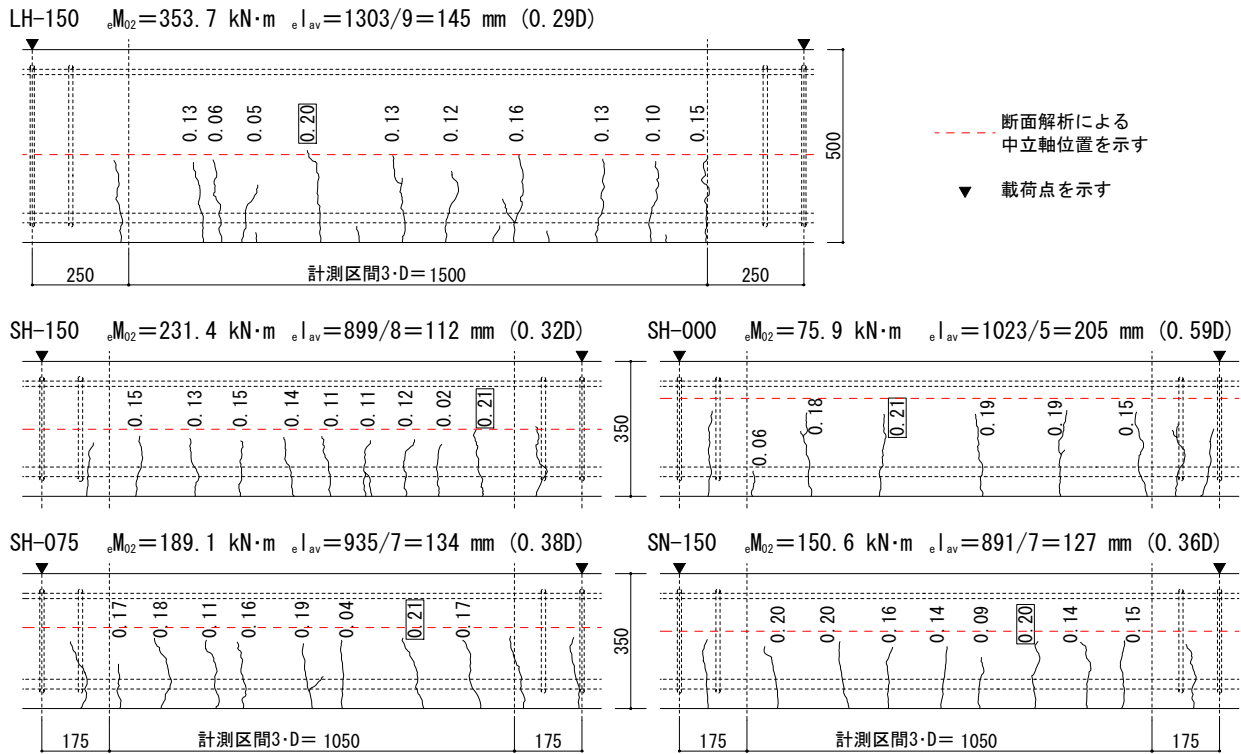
ひび割れ状況 ($eW_{max}=0.2\text{mm}$ 時)
